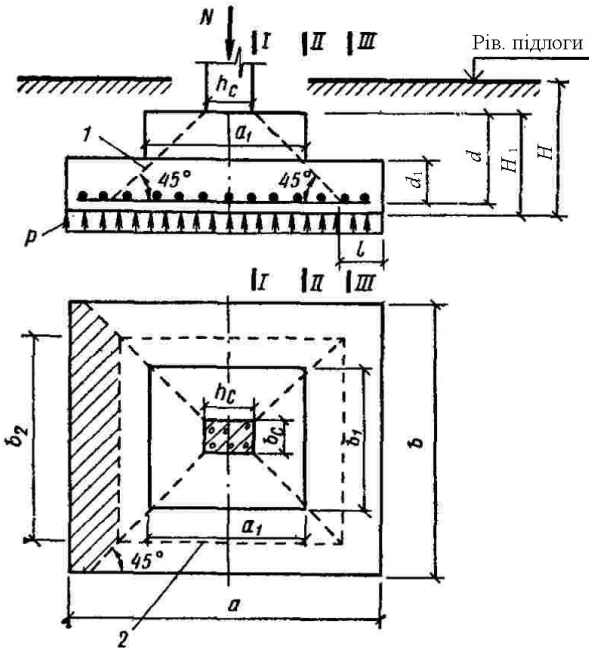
До розрахунку центрально-навантаженого фундаменту:
